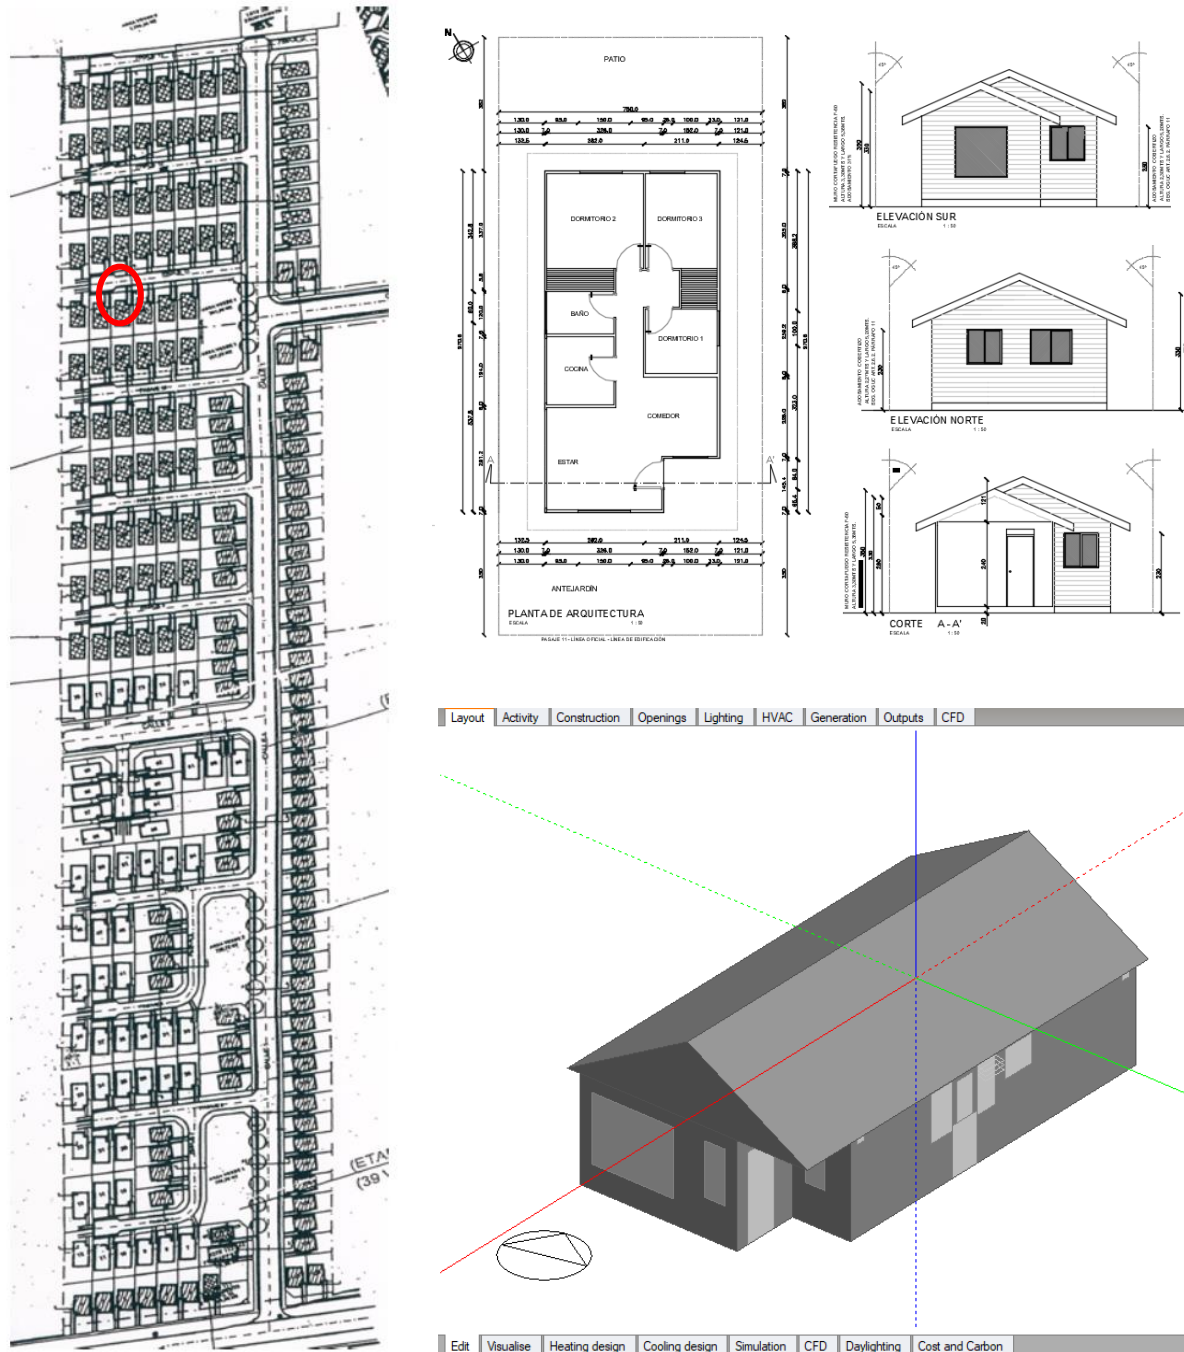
Plano de emplazamiento, planos de arquitectura y modelo Design Builder del Caso Base (fuente CERE - UMAG)
